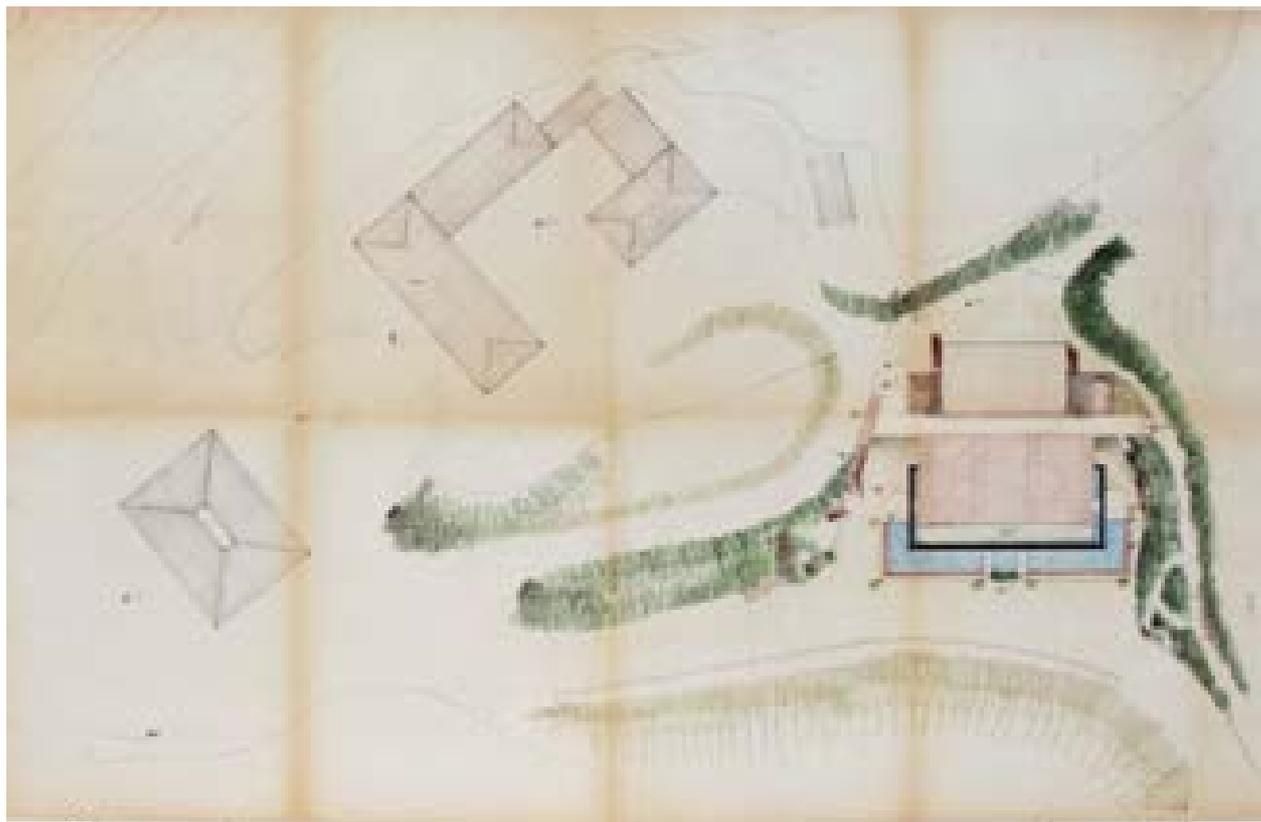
Planimetria generale, stato futuro – opere di completamento – 16/10/1997 (AABS-885)
